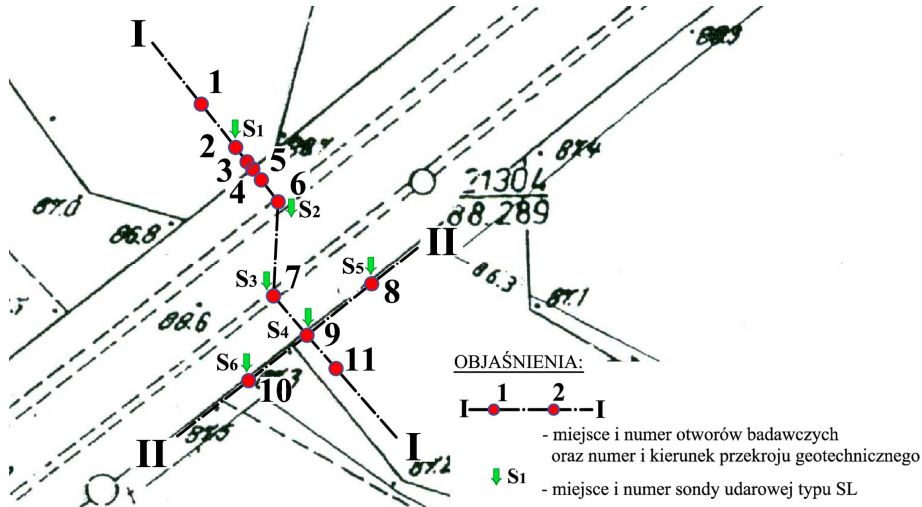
Plan sytuacyjny rozmieszczenia miejsc badawczych w km 83+180
